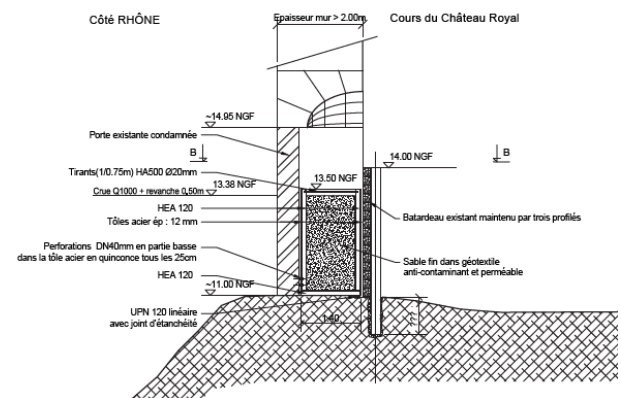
SCHEMA DU BATARDEAU CAISSON AUTO-PORTANT AU DROIT DE LA POTERNE - SOURCE : BRLI
